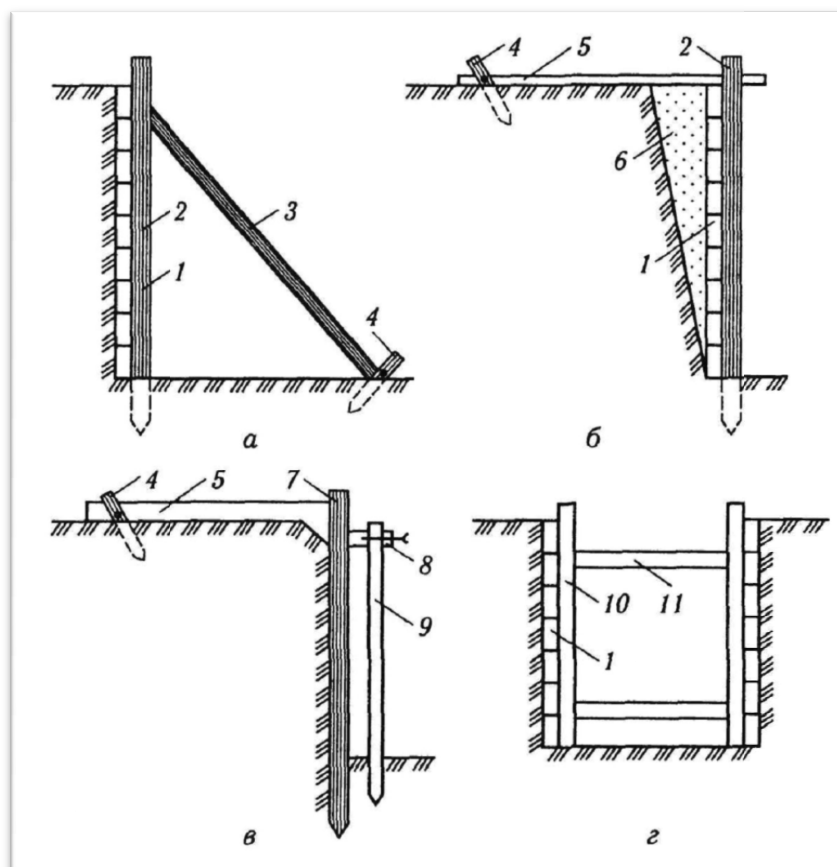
Кріплення стінок котлованів і траншей: а - підкісне; б - анкерне; в - шпунтове; г - розпірне; 1 - щити (дошки); 2, 10 - стояки; 3 - підкіс; 4 - паля; 5 - анкер; 6 - засипка; 7 - маякова паля (опорний стояк); 8 - напрямні; 9 - шпунт; 11 - розпірка
